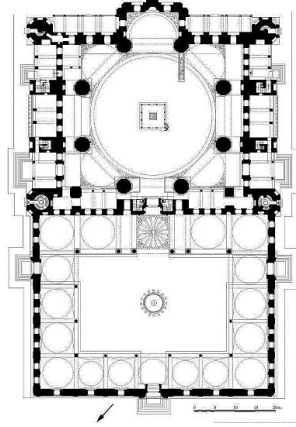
المسقط الأفقي لجامع خادم ابراهيم باشا في إستانبول
